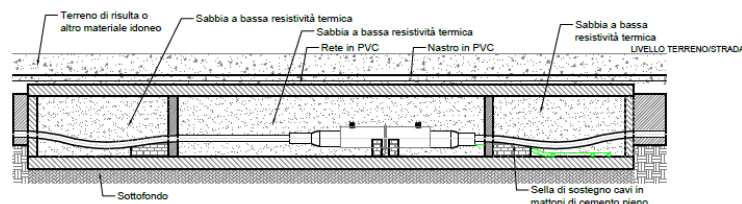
Pianta e sezione tipo della buca giunti prefabbricata. Tavola tipologico buche giunti.
